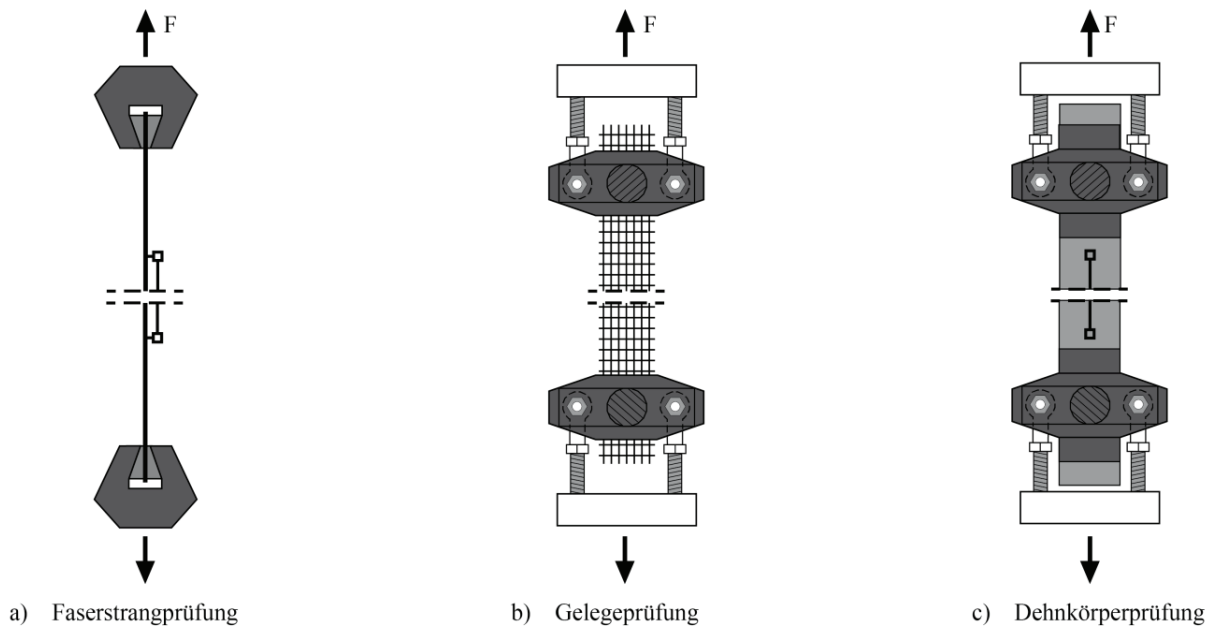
Zugprüfapparatur für textile Bewehrungen nach [Bie17]: a) Faserstrang, b) Gelegeausschnitt, c) Dehnkörper
